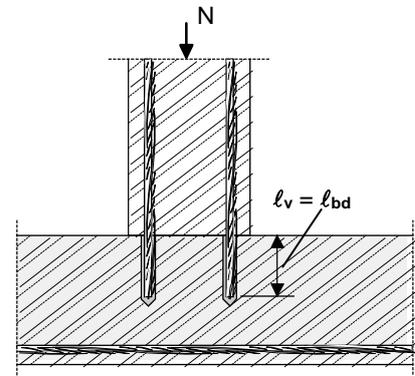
Recouvrement d'armatures pour la liaison d'un poteau ou d'un mur sur une fondation avec armatures en traction
